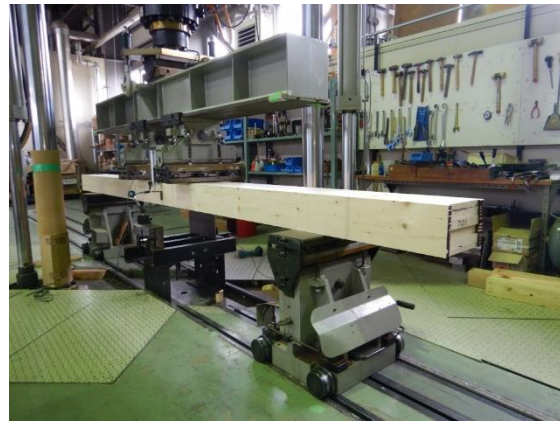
曲げ試験の様子（トドマツ）
